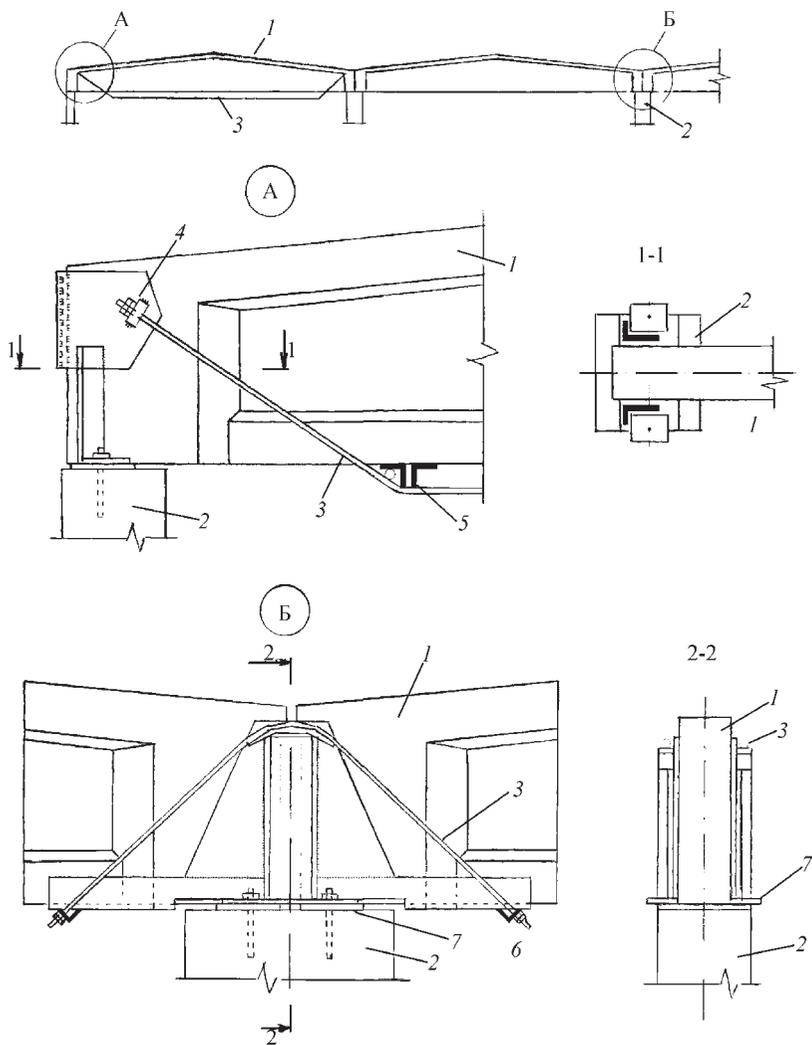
Усиление стропильных балок шпренгелем (А) или двухконсольной фермой (Б):
